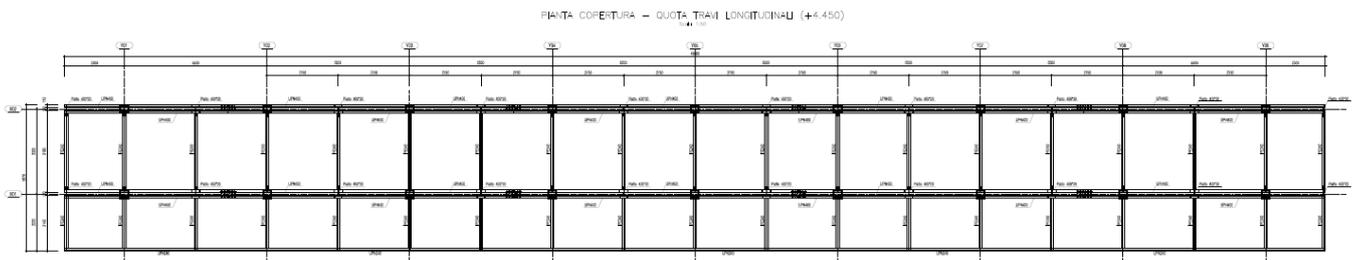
Pensiline – Pianta Copertura quota +4.450 - Pensilina Nord
